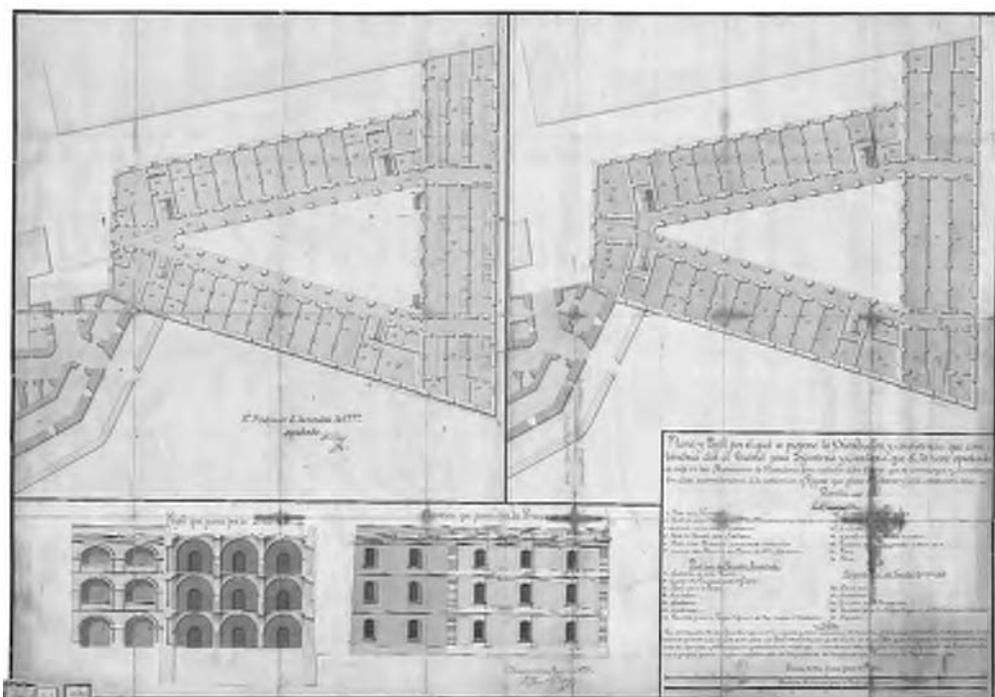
Plano y perfil del Cuartel Nuevo para Infantería y Caballería. Francisco Llobet. 1777. IHCM. B-55-13.
